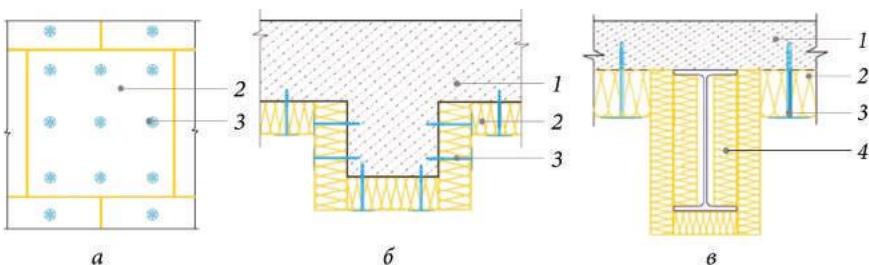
Системные решения огнезащиты бетонных плит: а — схема расположения крепежных элементов на плите размером 1200×1200 мм; б — устройство огнезащиты железобетона на выступе; в — узел состыковки огнезащитных плит для изоляции конструкции из металла и из бетона; 1 — железобетонная плита перекрытия; 2 — плита огнезащитная для изоляции конструкции из бетона; 3 — металлический анкер и рондель; 4 — плита огнезащитная для изоляции конструкций из металла
